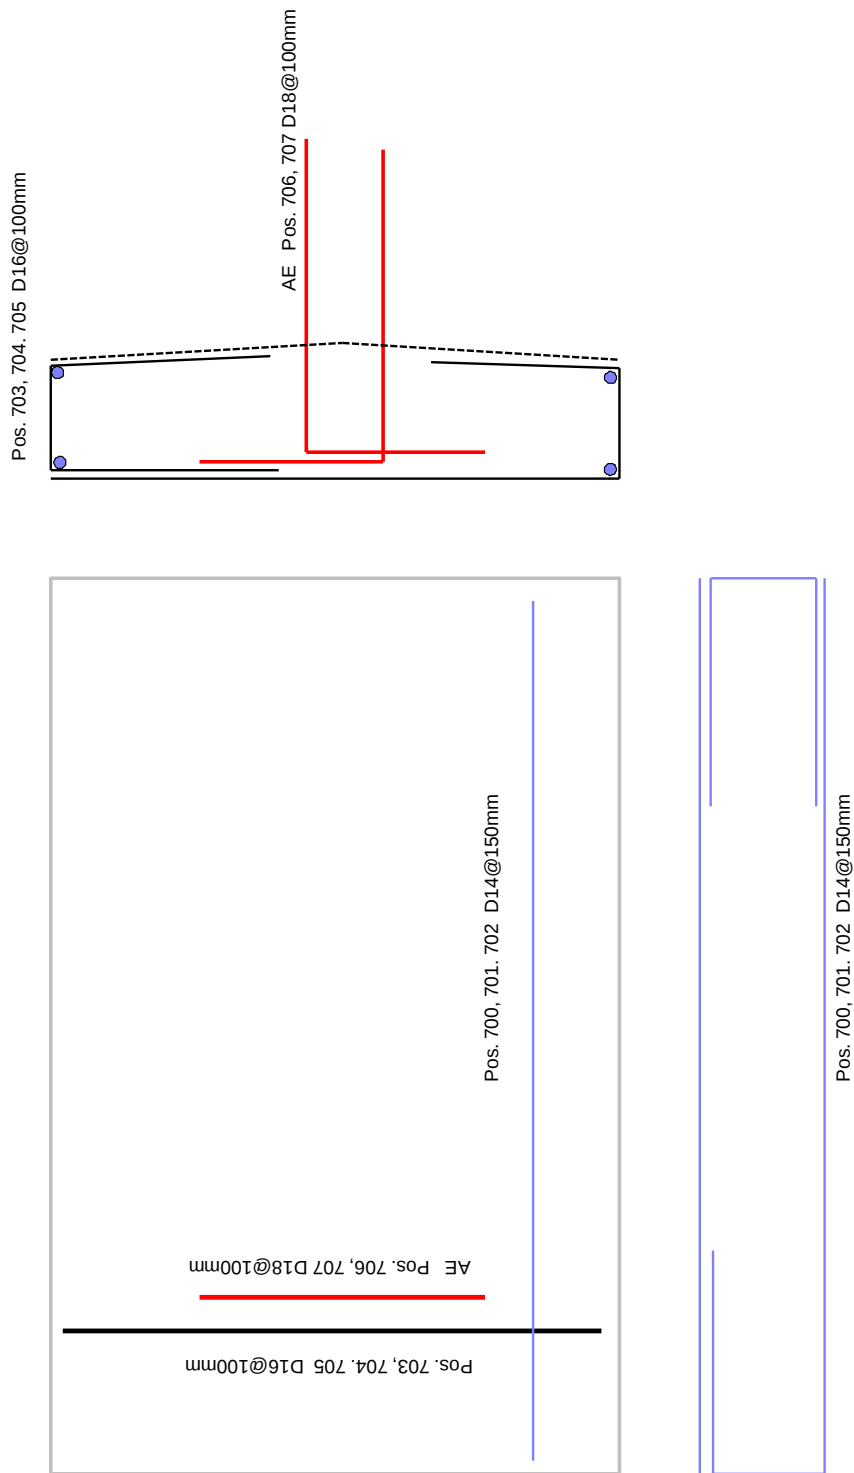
Anschlusseisen, Längs- und Querbewehrung in den Fundamenten
